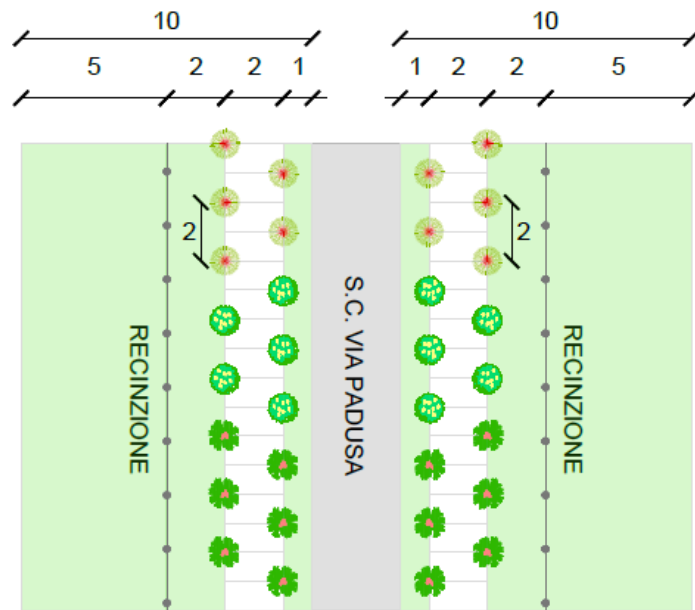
Schema d’impianto della siepe lungo la S.C. Via Padusa.
